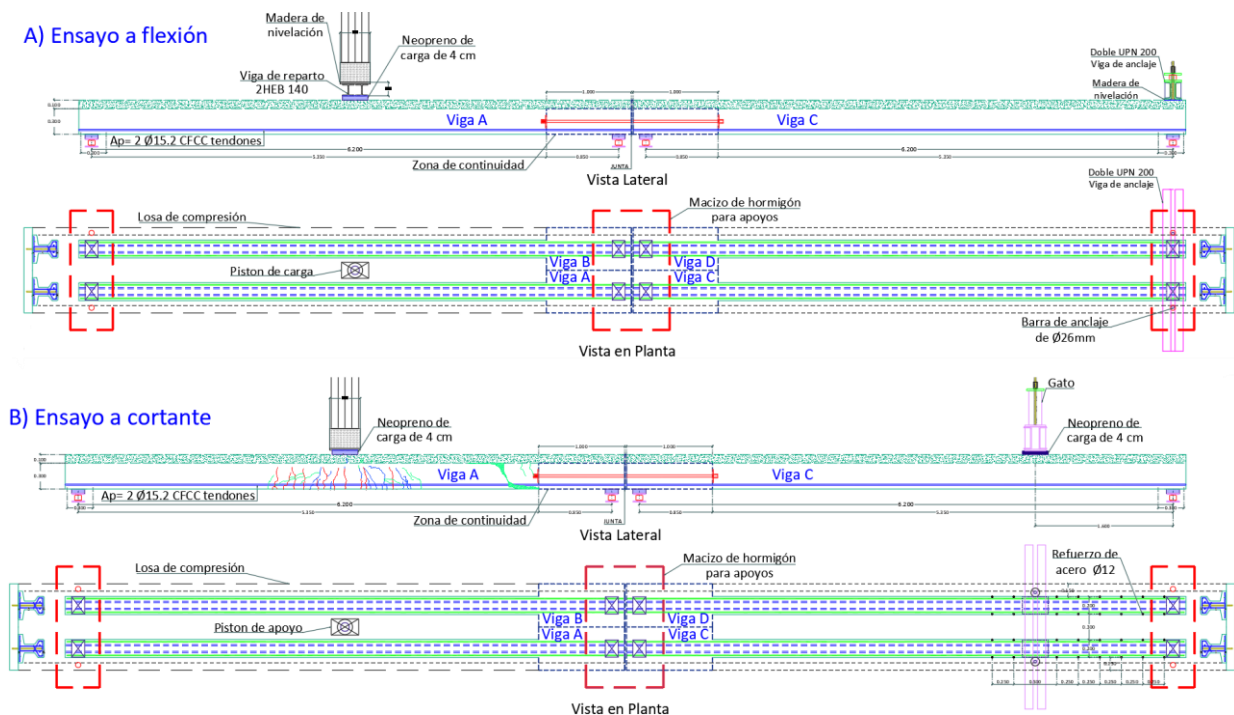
Configuración del ensayo a flexión (a) y del ensayo a cortante (b) en planta y alzado.
